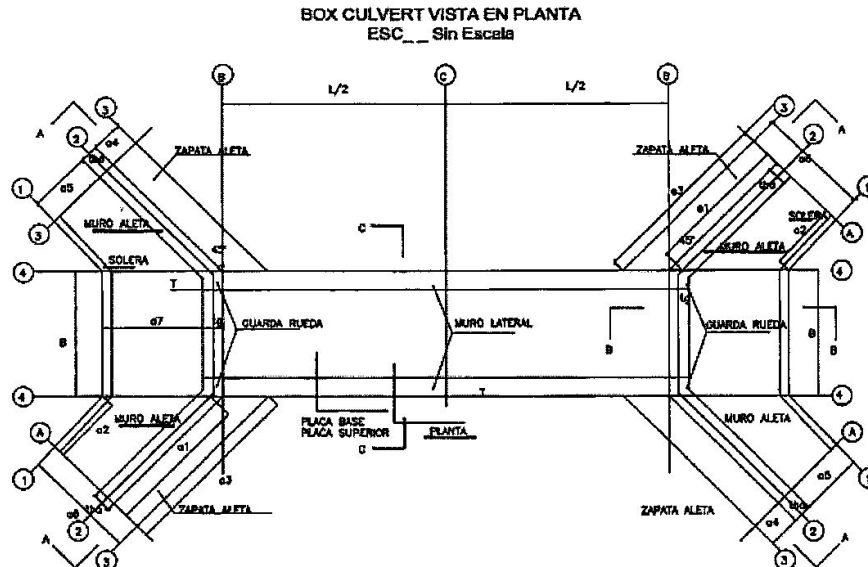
Vista en planta de la estructura del Box-Culvert a realizar sobre el cauce del Arroyo Mano de Dios. Fuente: Planos entregados por el Solicitante.
